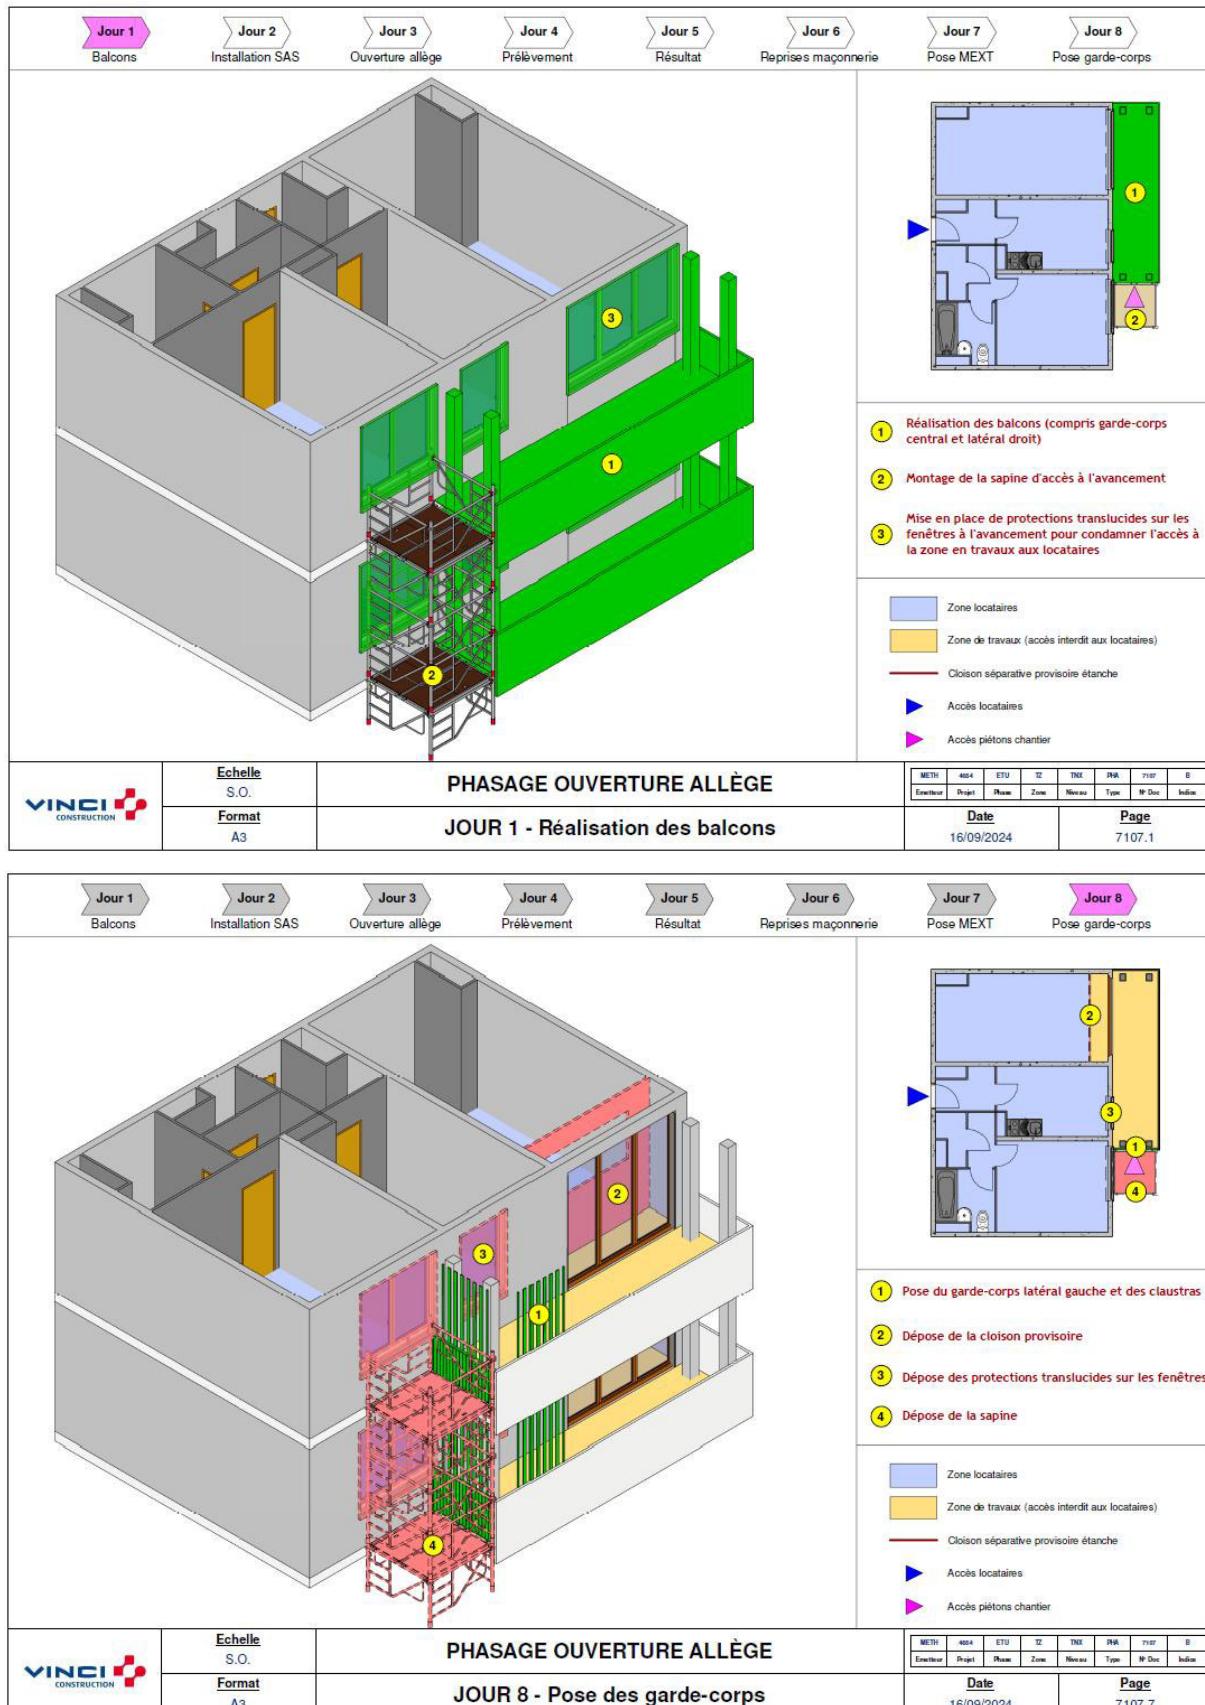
Extrait du phasage des travaux de façade (Source: VINCI construction, 16/09/2024)
